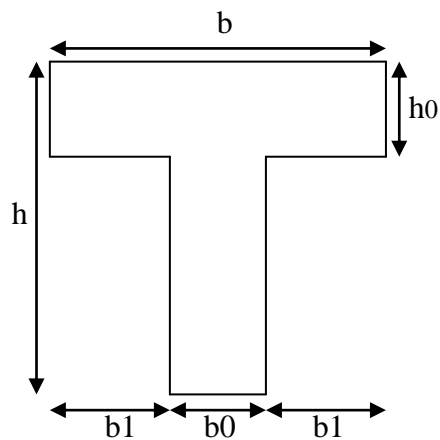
Schéma d'une poutrelle du 3^{eme} jusqu'au 12^{eme} étage
